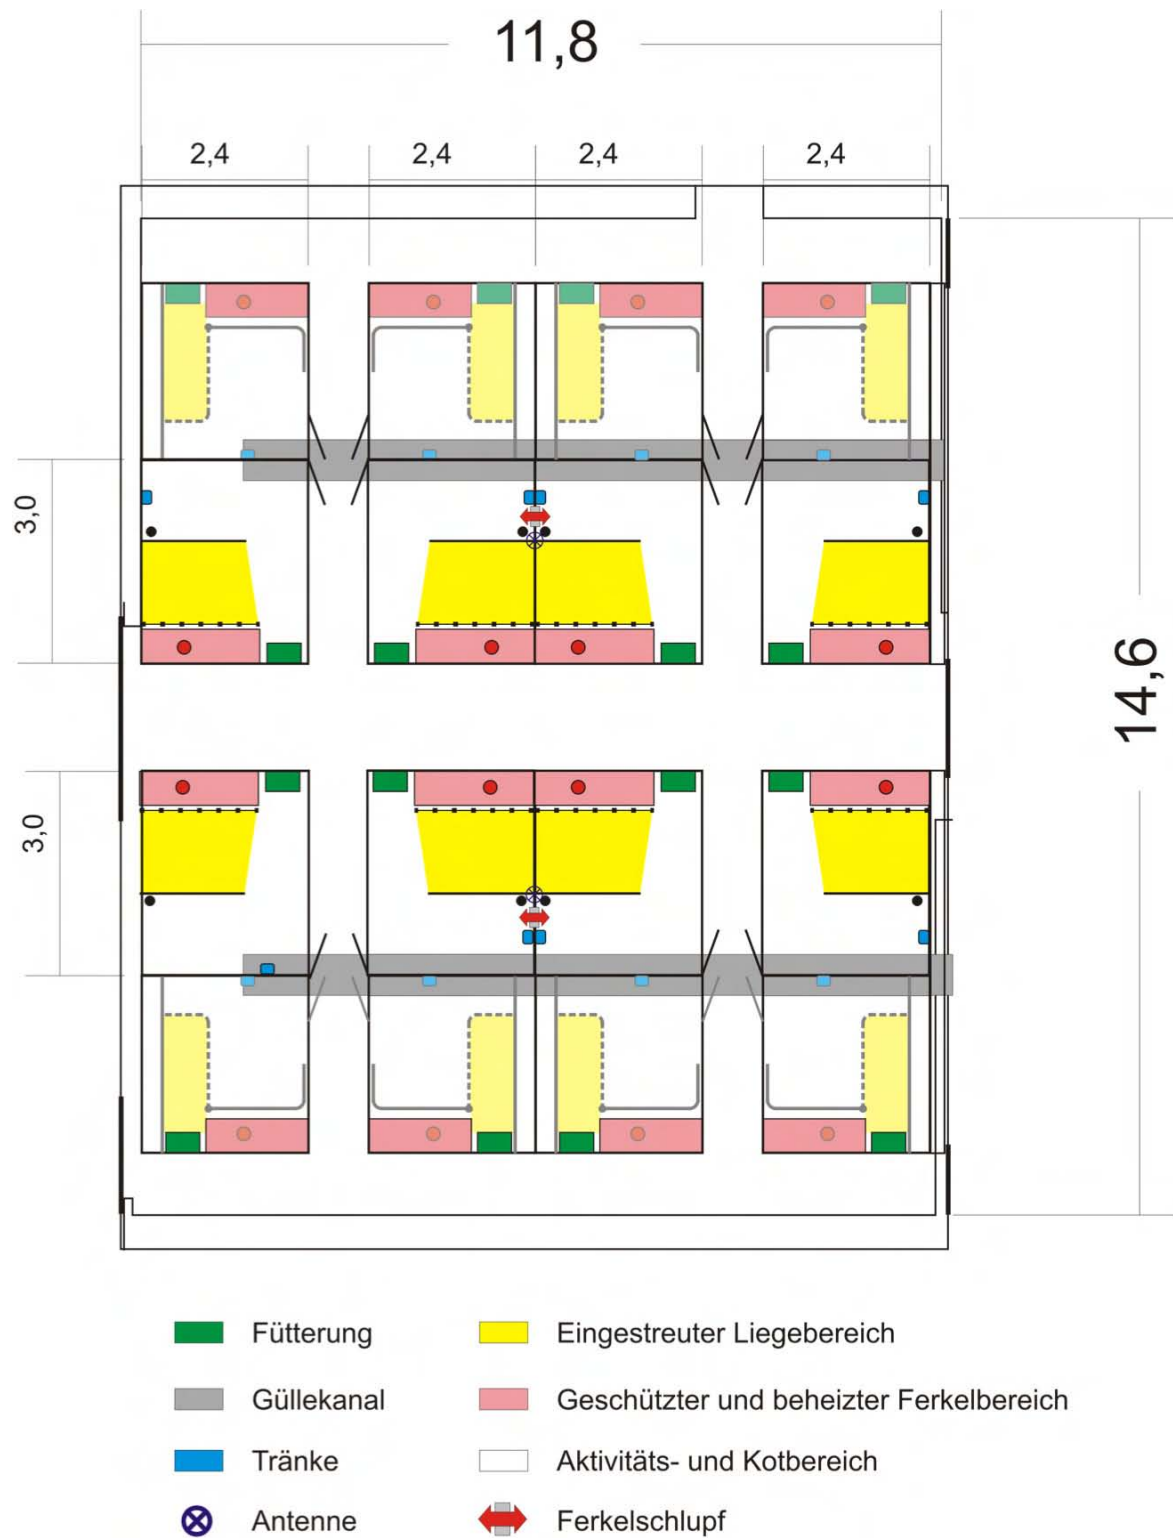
Grundriss Bünge-Stall, Anteil mit Bewegungsbuchten (genutzt wurden die acht Mittelbuchten vom Typ FAT2; Angaben in m)
